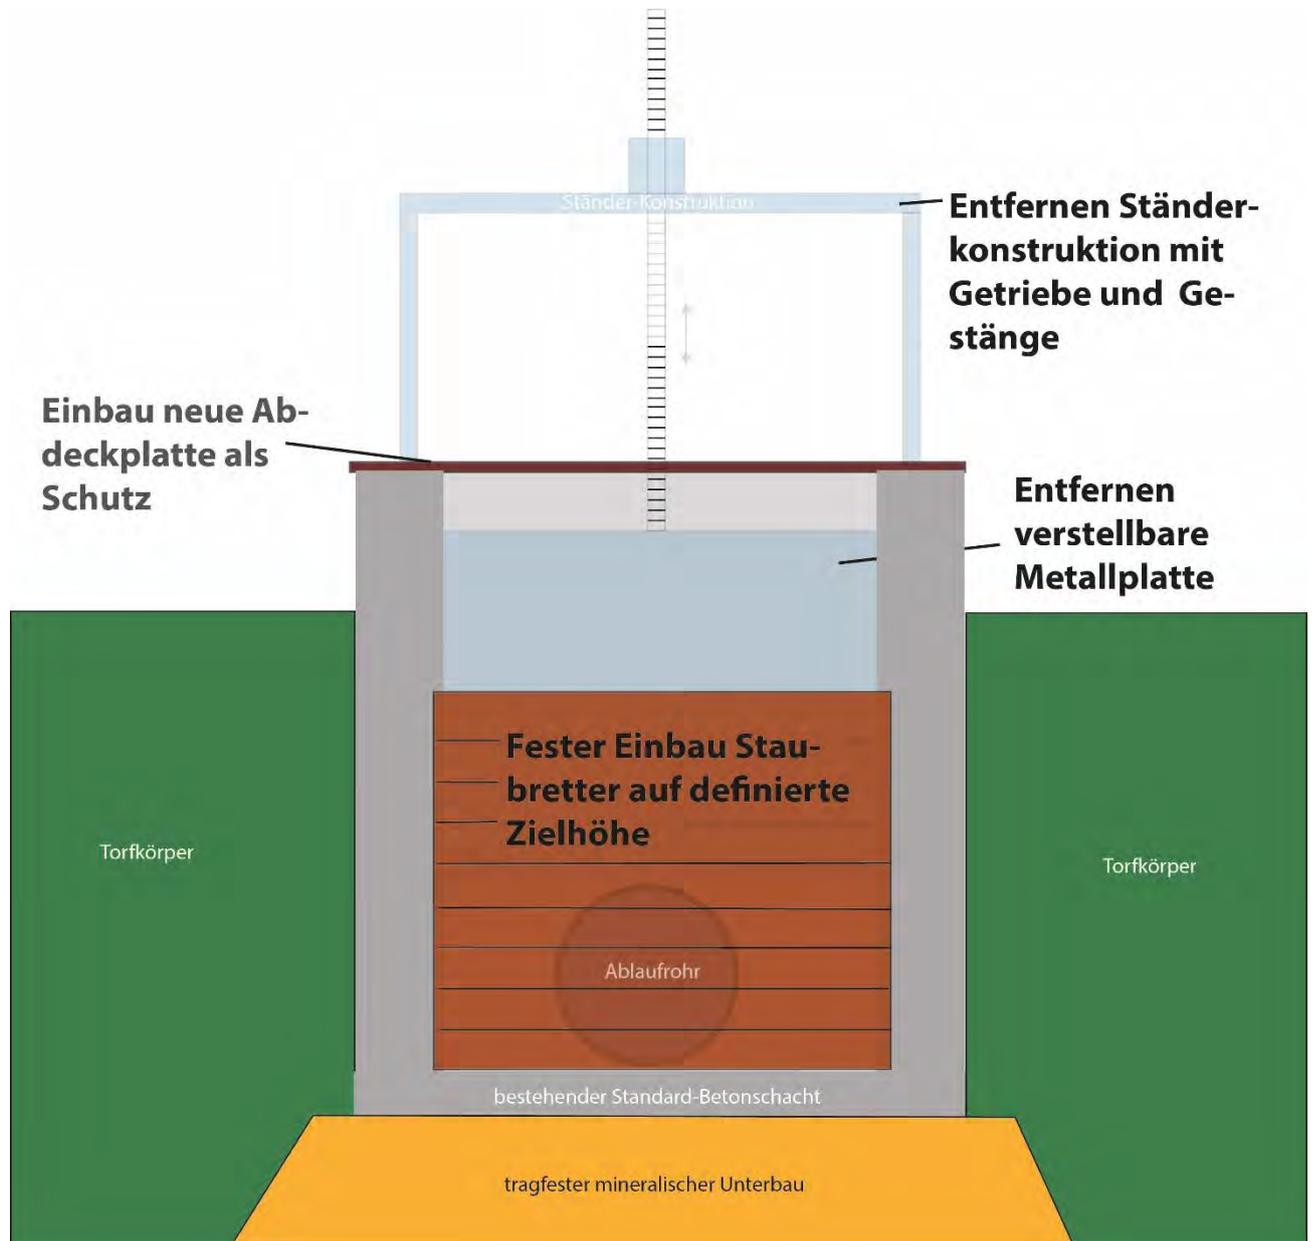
Umbau Stauschacht zum Schacht-Mönch als Alternative zum Bau der Sohlrampen (Prinzipskizze - Frontansicht)
